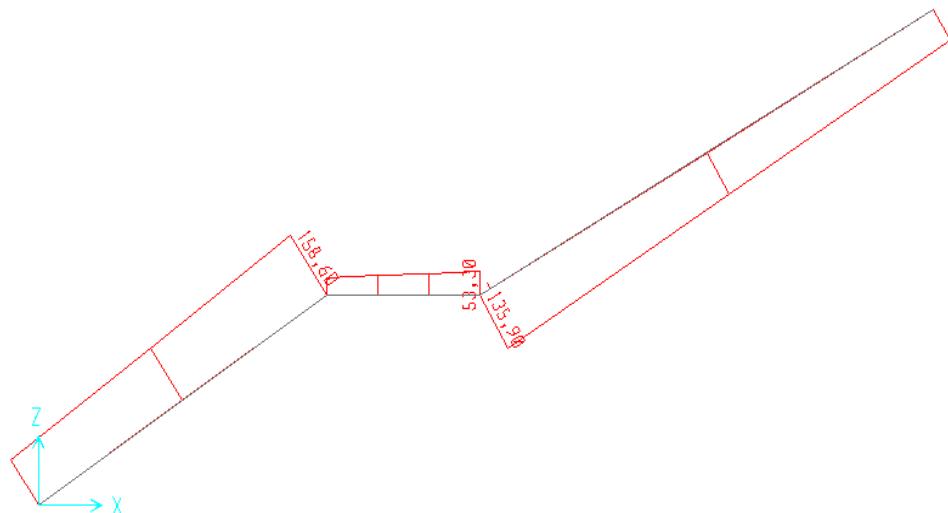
Diagram Beban Mati tangga Lantai 2
